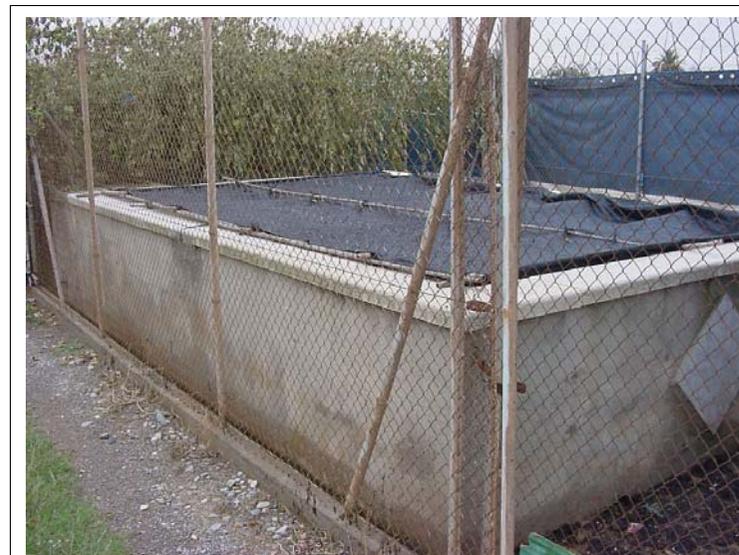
Balsa de 1.20 m de altura en hormigón.
